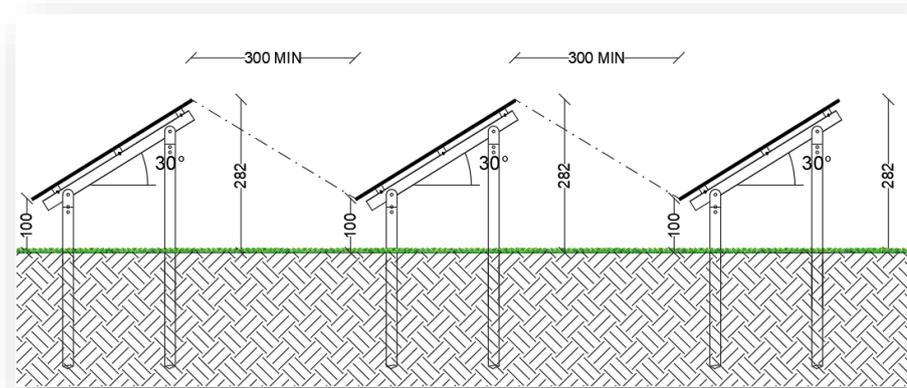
Sezione tipo impianto con installazione su strutture ad orientamento fisso
